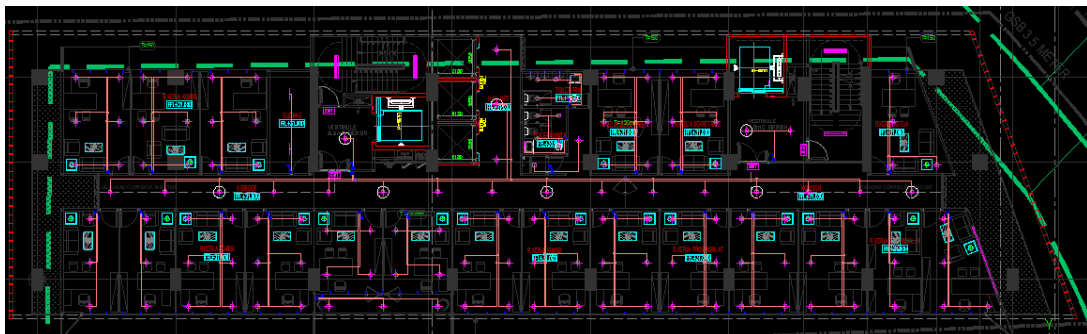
Instalasi Titik Penerangan dan Wiring Proyek HBB Batam – Unit
